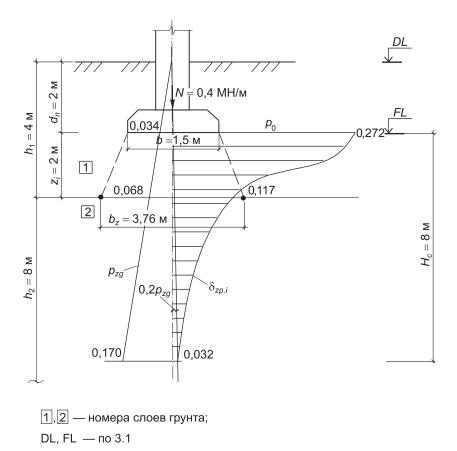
Расчетная схема основания фундамента к примеру Г.8
